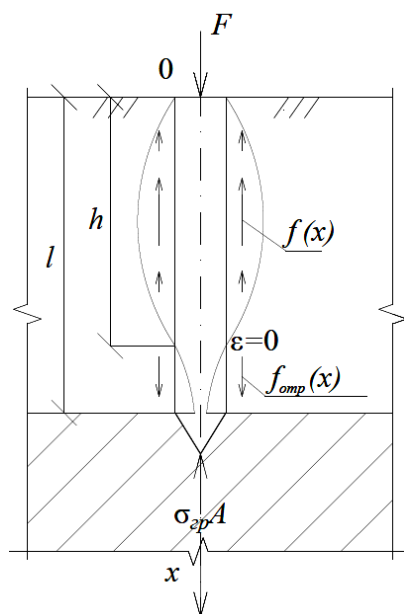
Расчетная схема работы сваи-стойки в расчетах на осадку
